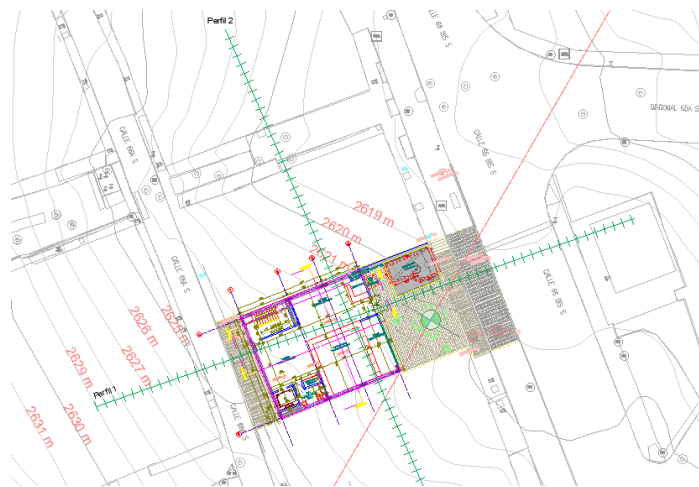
Vista en Planta perfil 1 y perfil 2
